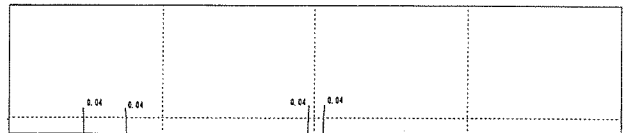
ひび割れ発生図（第3ブロック中壁）
